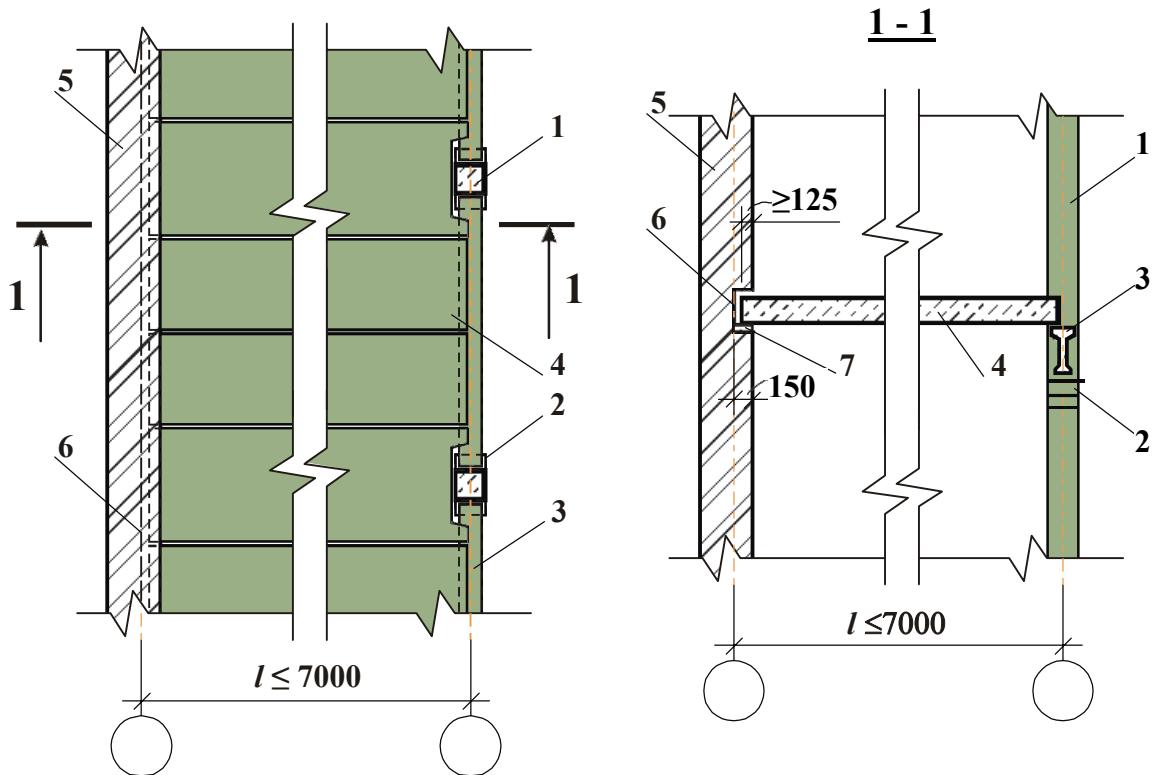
Конструкція перекриття з неповним внутрішнім залізобетонним каркасом:
